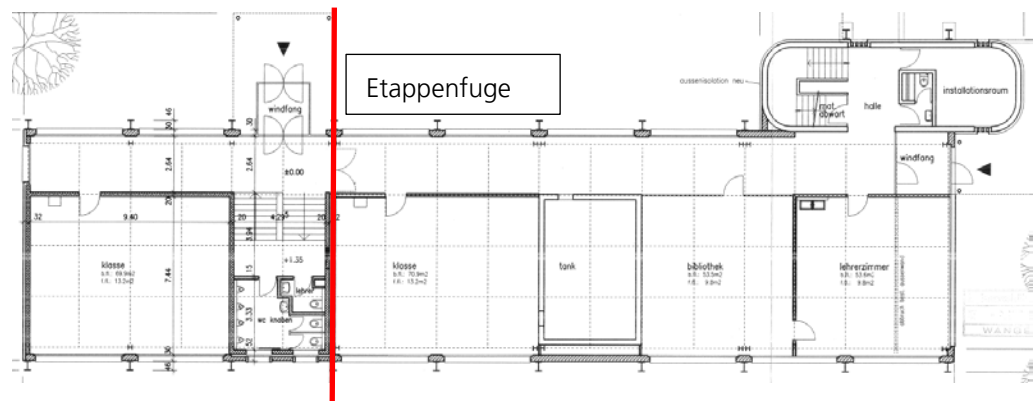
Etappenfuge Grundriss EG Etappe 1 und 2
